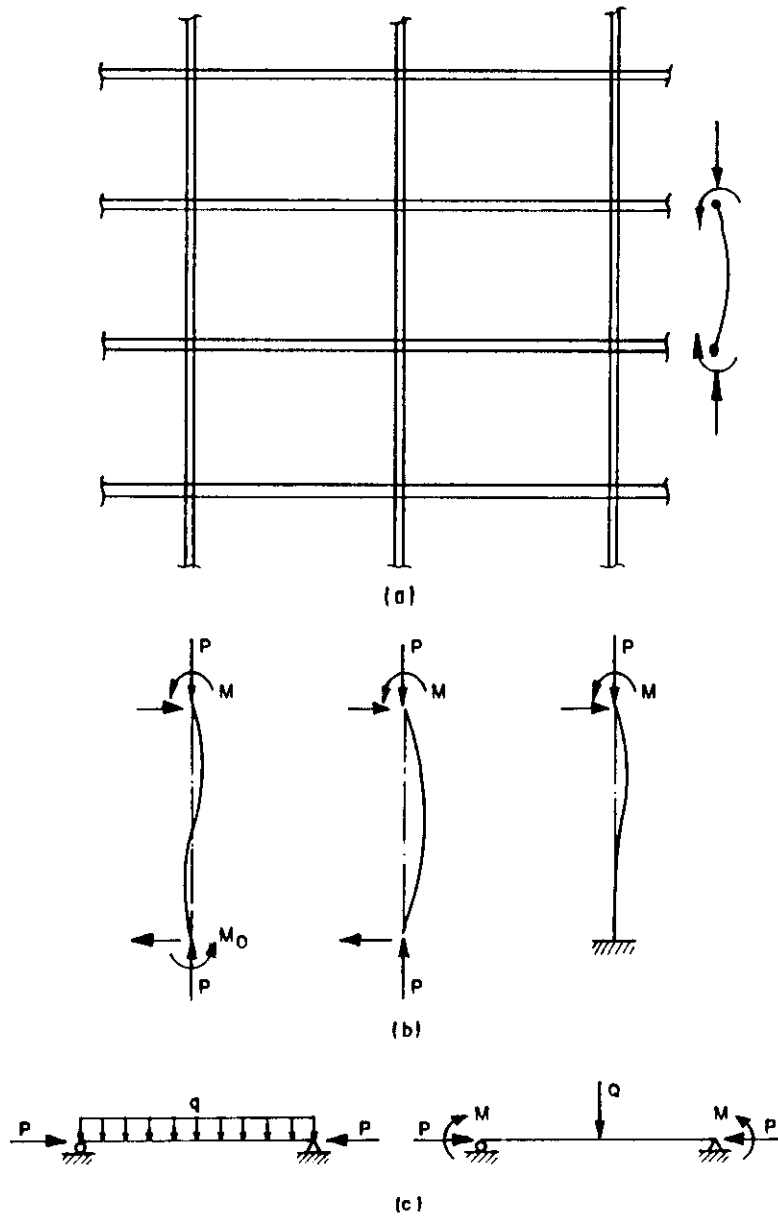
Vigas-colunas: (a) Vigas-colunas em um pórtico; (b) vigas-colunas típicas de pórticos; (c) vigas-colunas típicas com cargas transversais.
